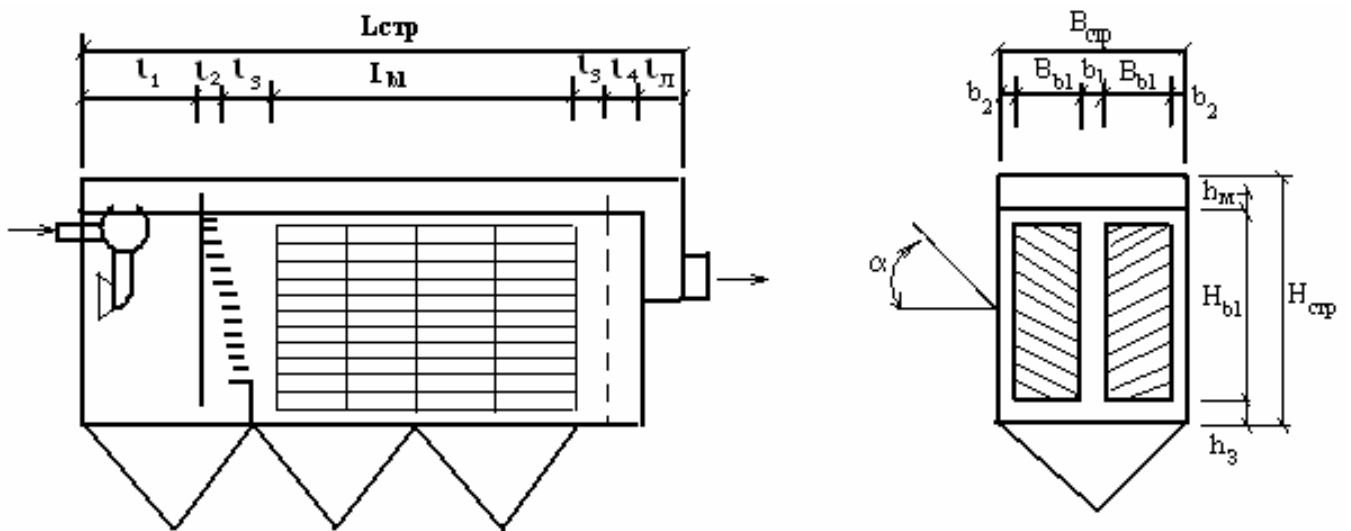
Схема тонкослойного отстойника, работающего по перекрестной схеме удаления осадка
